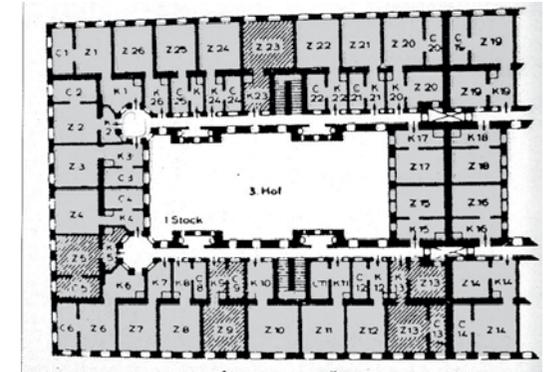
Planta tipo propuesta como mejora a la vivienda especulativa: de las *Bassena Haus* a las *Hof* vienesas.
